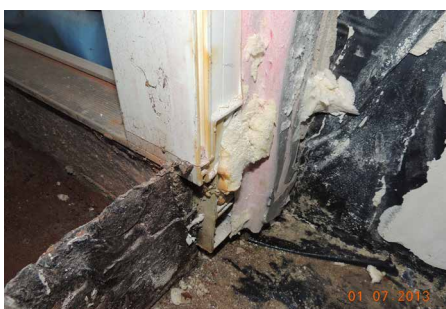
Nach Rückbau des Verblendmauerwerks vorgefundene Anordnung der jeweiligen Abdichtungen
